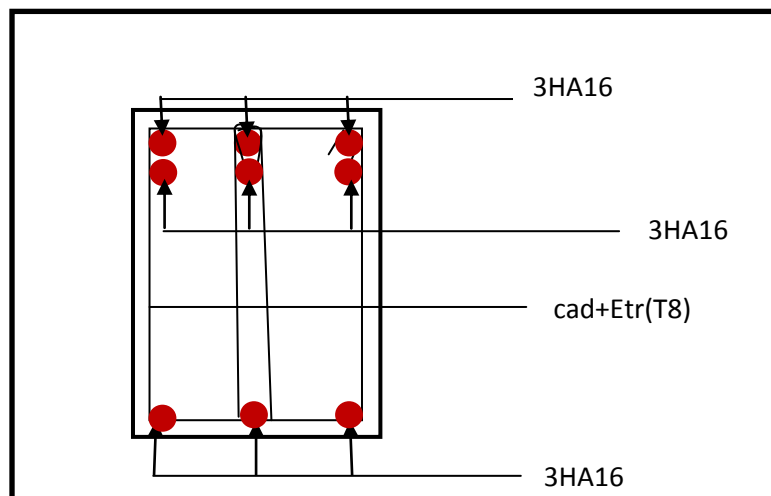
Ferraillage sur appuis d'une poutre principale.
